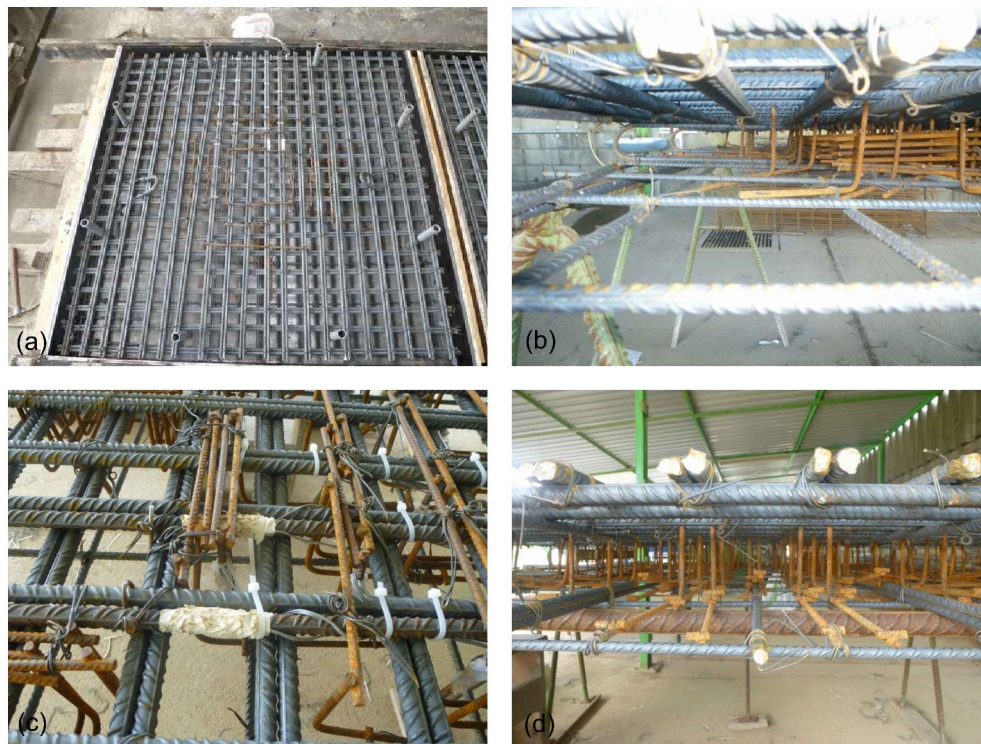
(a) Colocação dos negativos para os furos; (b) Pormenor dos espaçadores; (c) Pormenor das armaduras de punçoamento atadas na armadura longitudinal superior; (d) Pormenor das armaduras de punçoamento atadas na armadura longitudinal inferior.
